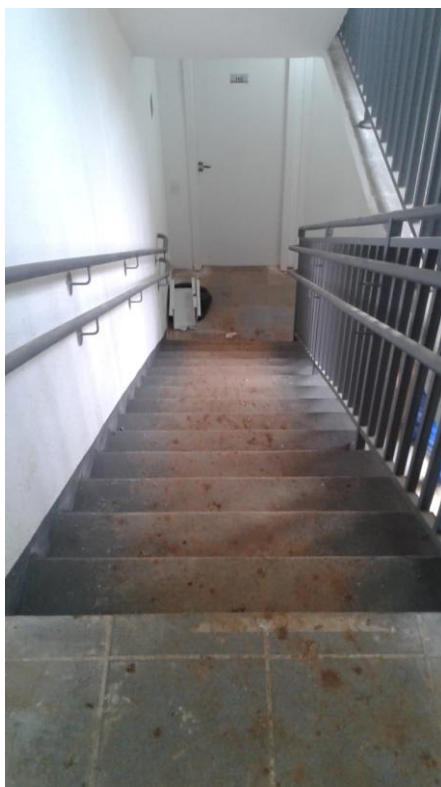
Escada entre o térreo e o primeiro pavimento da torre 1. (Fonte: autora)
